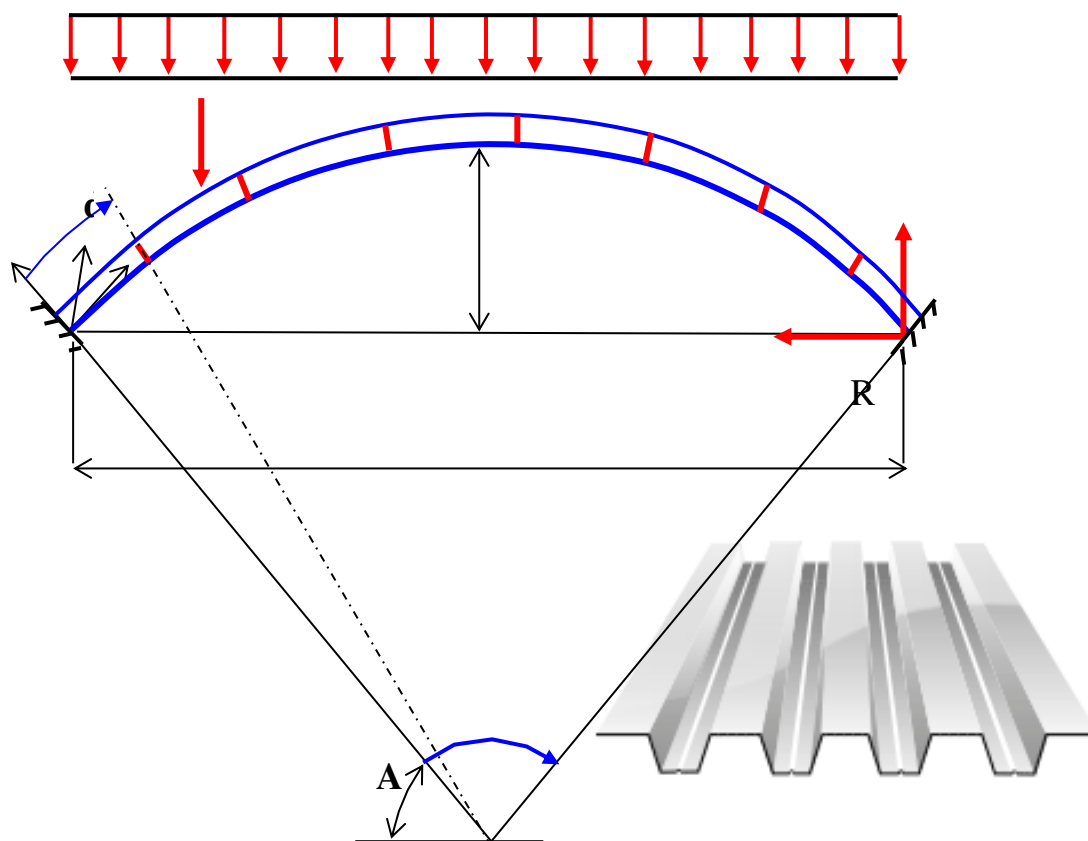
Второе основное сочетание нагрузок на арочное покрытие
